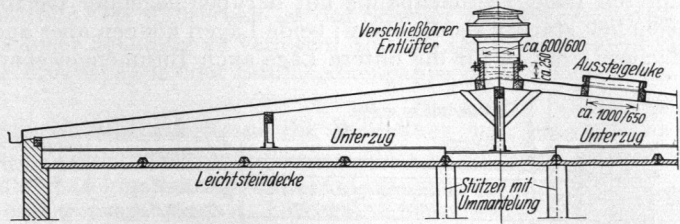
Dachdecke als Raumabschluß des obersten Geschosses mit darüber liegendem Schutzdach (s. auch Abb. 98).
